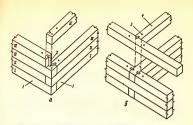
Схемы сопряжения брусьев наружных (a) и наружной и внутренней (б) стем на випадных шпонках:
